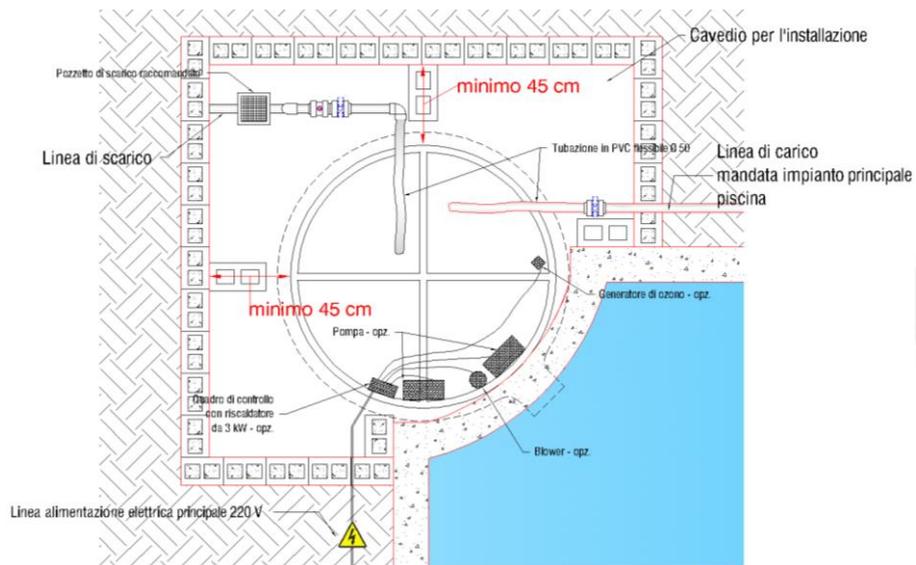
Installazione ad angolo- cavedio tipo per installazione – cavedio circolare
